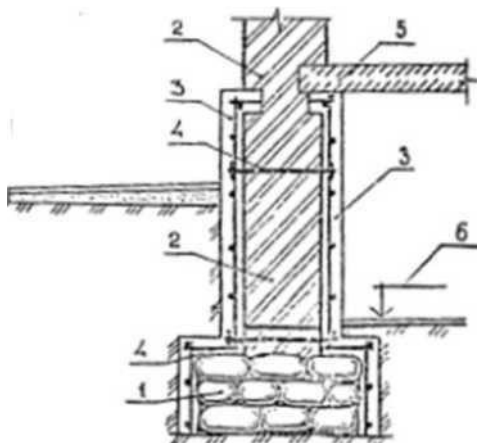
Укрепление стен подвала и фундамента устройством обоймы: 1-усиливаемый фундамент; 2- кирпичная стена; 3- железобетонная обойма; 4- анкеры; 5- надподвальное перекрытие; 6- отметка пола подвала.
